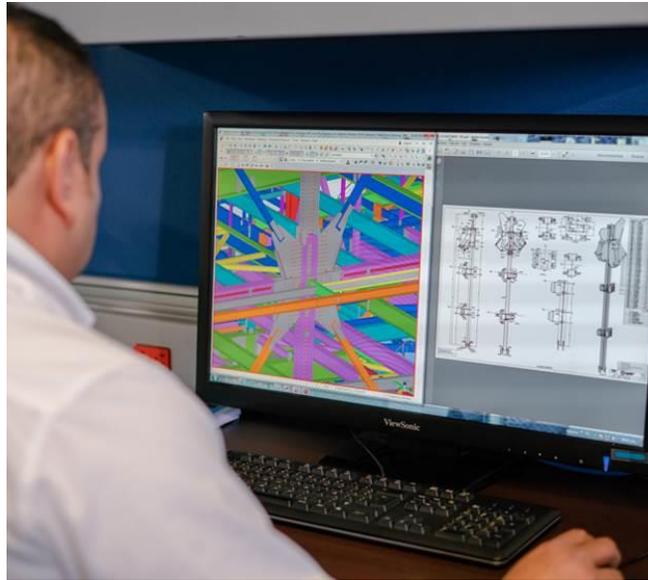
Servicio de ingeniería de detalle de Grupo Recal
